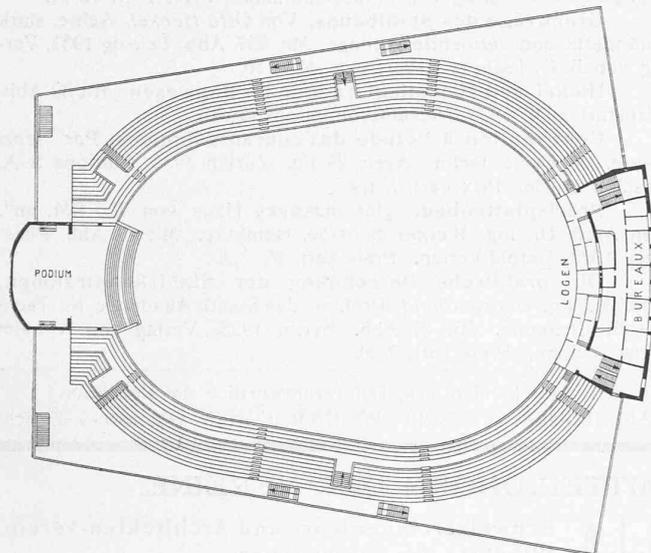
Grundriss der Tribünen. — Masstab 1 : 1200.
